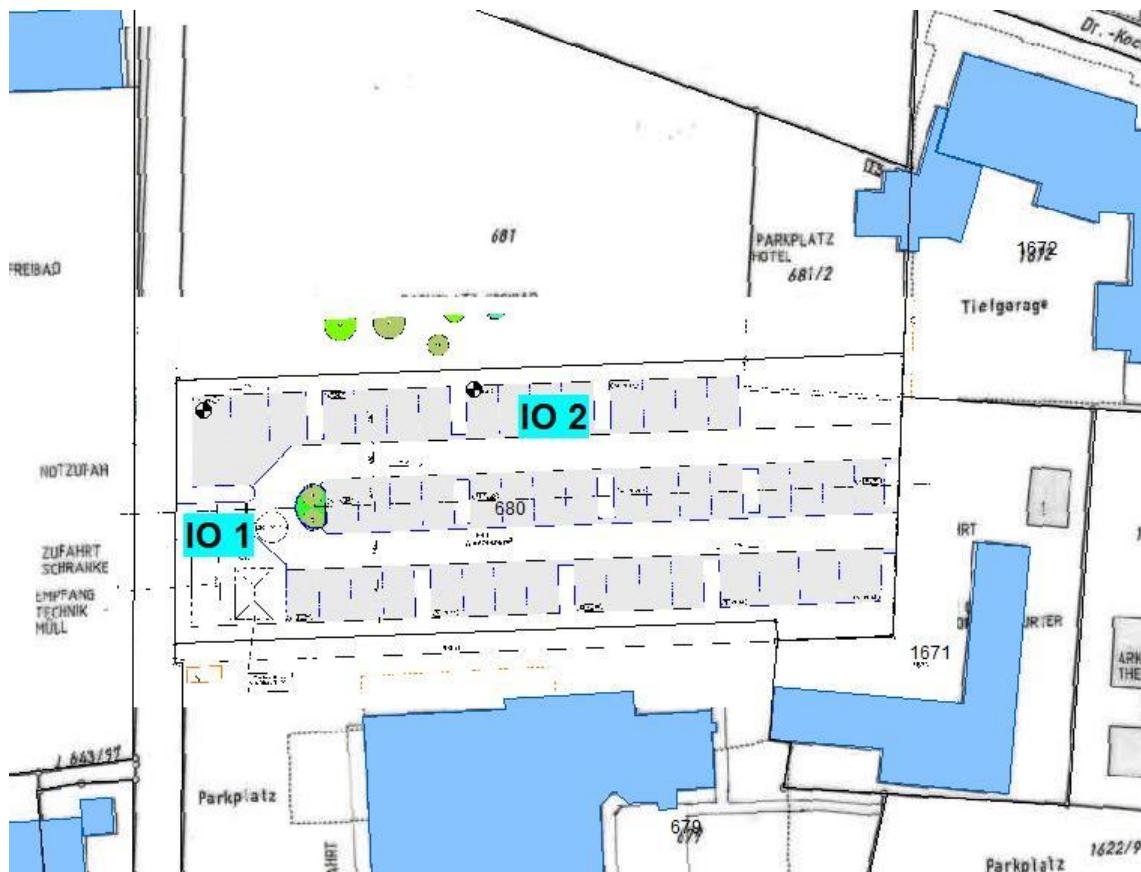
Lageplan mit Kennzeichnung Immissionsorte IO
